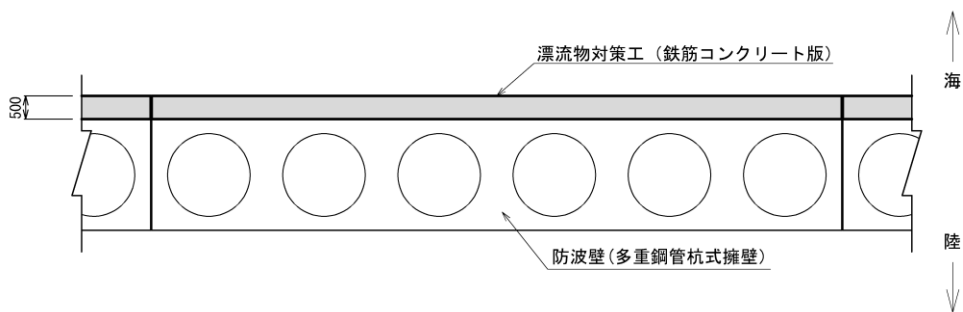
(1) 漂流物対策工（鉄筋コンクリート版）の構造概要図（平面図）
